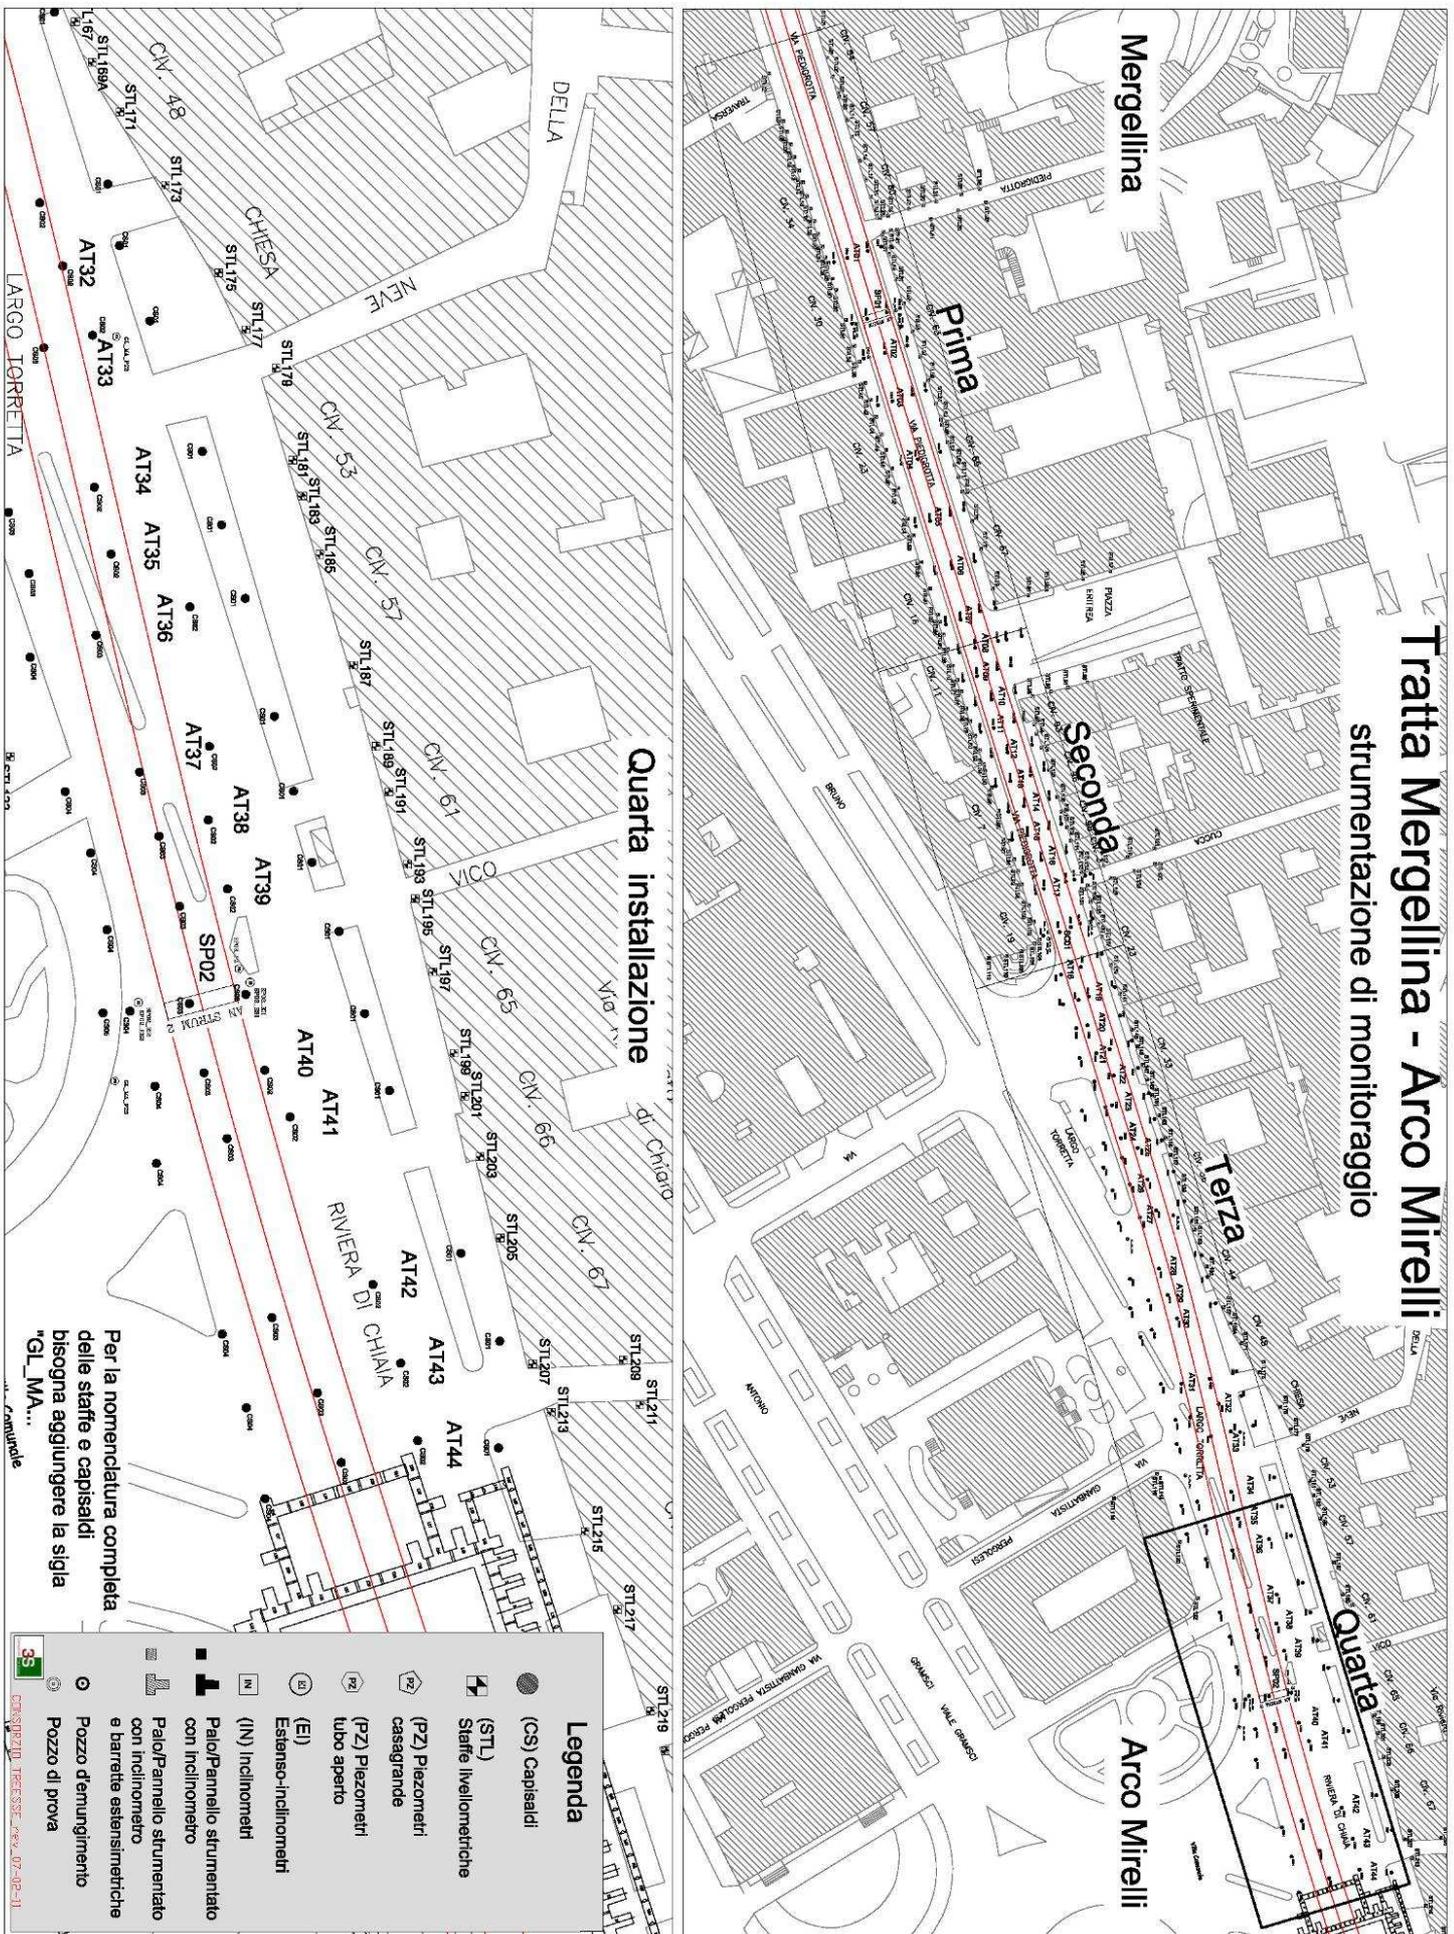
Planimetria tratta Mergellina - Arco Mirelli, raffigurante la disposizione della quarta installazione della strumentazione di monitoraggio.
